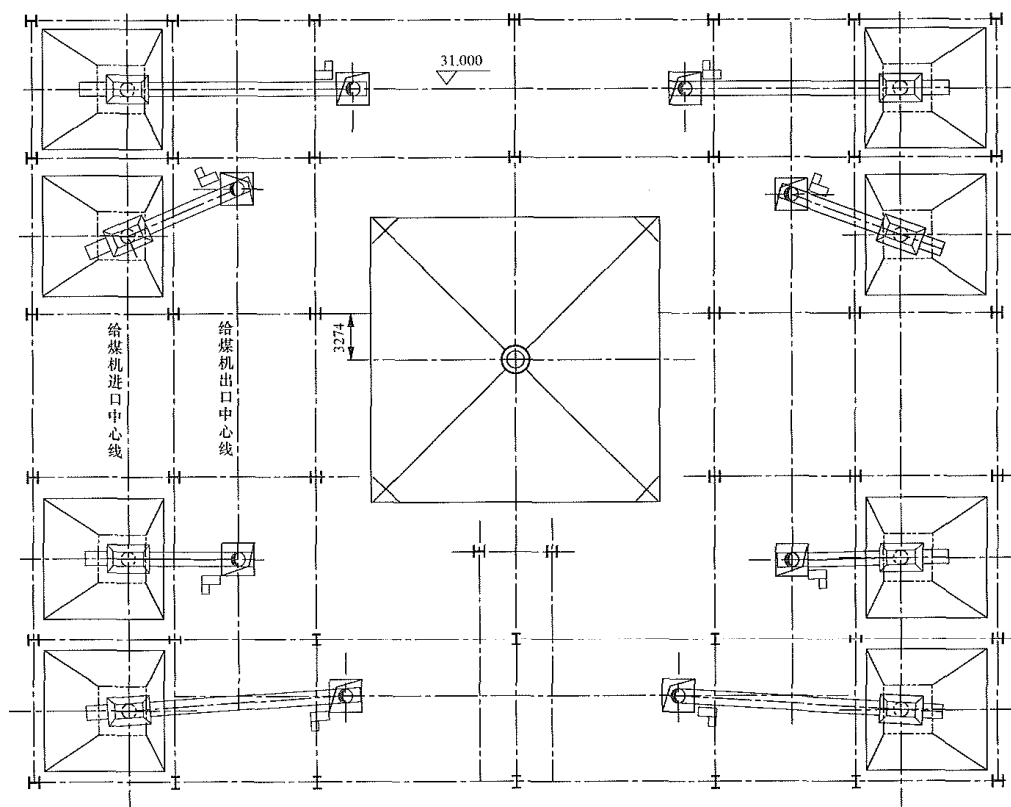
600MW 级机组风扇磨煤机侧煤仓给煤机层平面布置图
